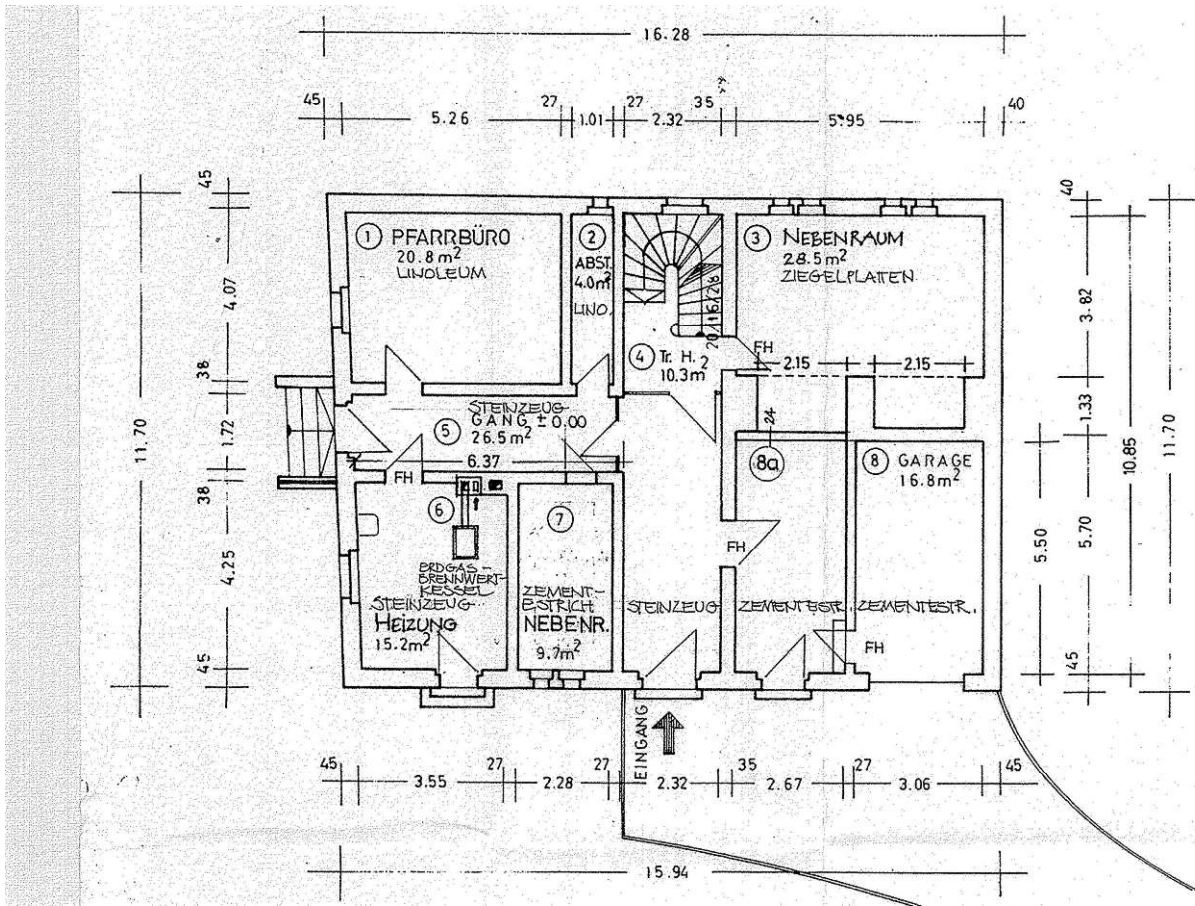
Bestandsplan des Pfarhauses, Erdgeschoss, 2004
